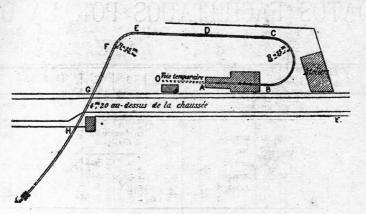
Plano de la via de ensayo construida en Cambridge, cerca de Boston.
